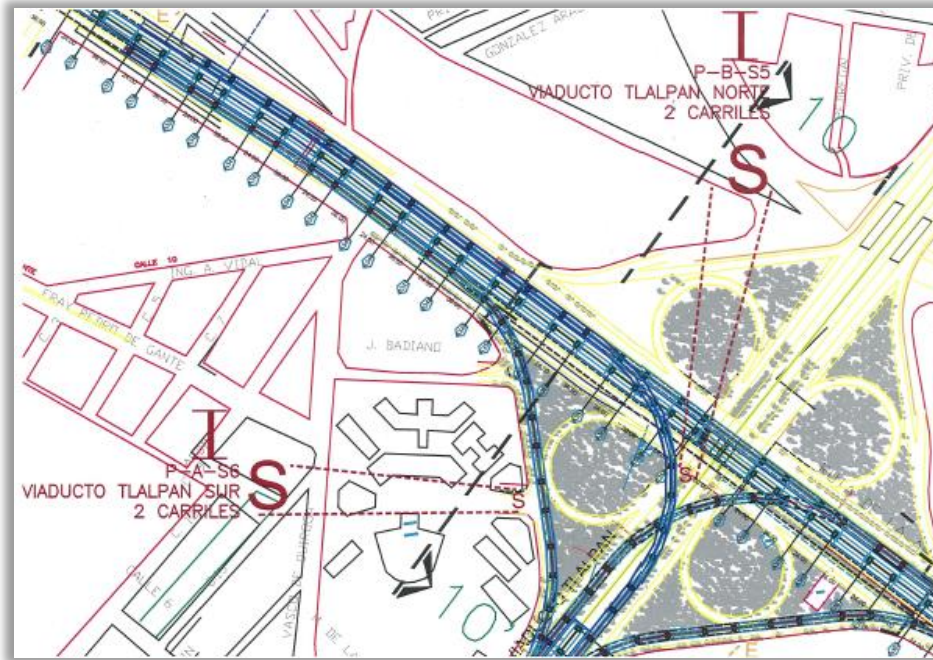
Entrada por Viaducto Tlalpan Norte y salida por Viaducto Tlalpan Sur
